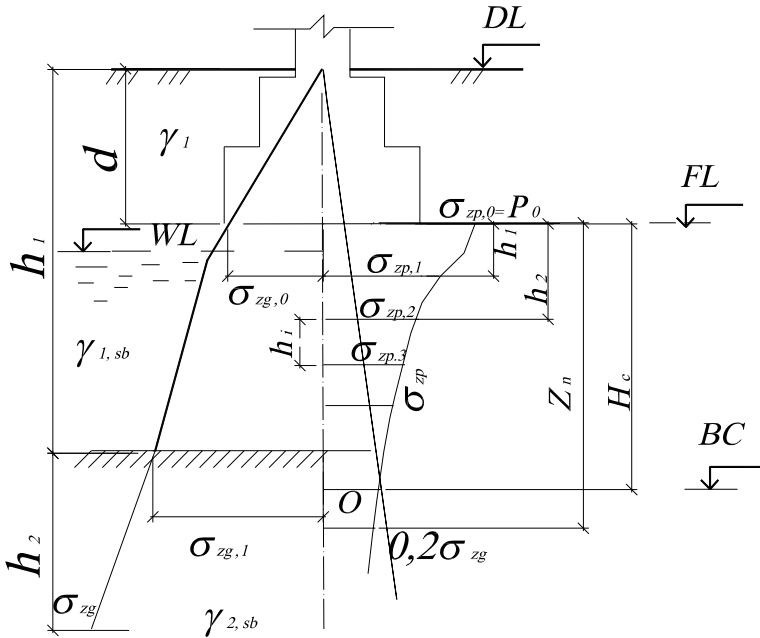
Схема для расчета осадки фундамента мелкого заложения методом послойного суммирования
